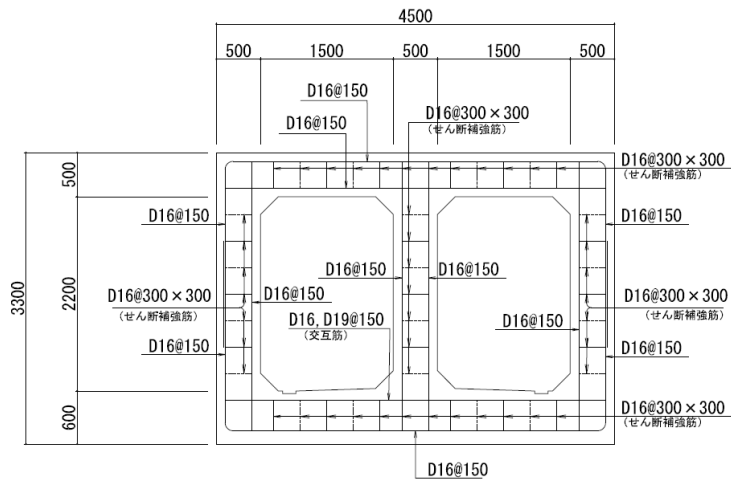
燃料移送系配管ダクト断面図 (B-B 断面)
